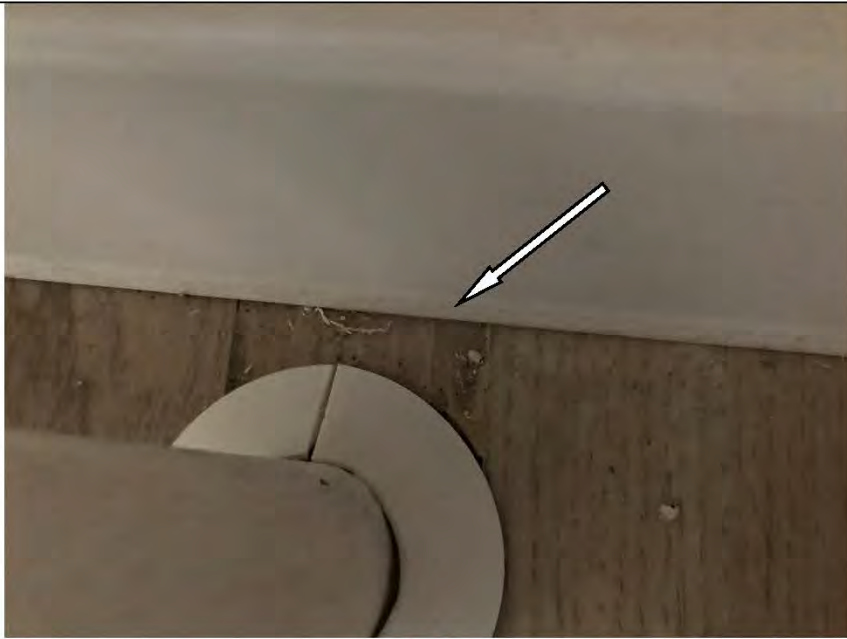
Дефект вставки труб отопления в напольное покрытие из ламината в кухне в квартире.
